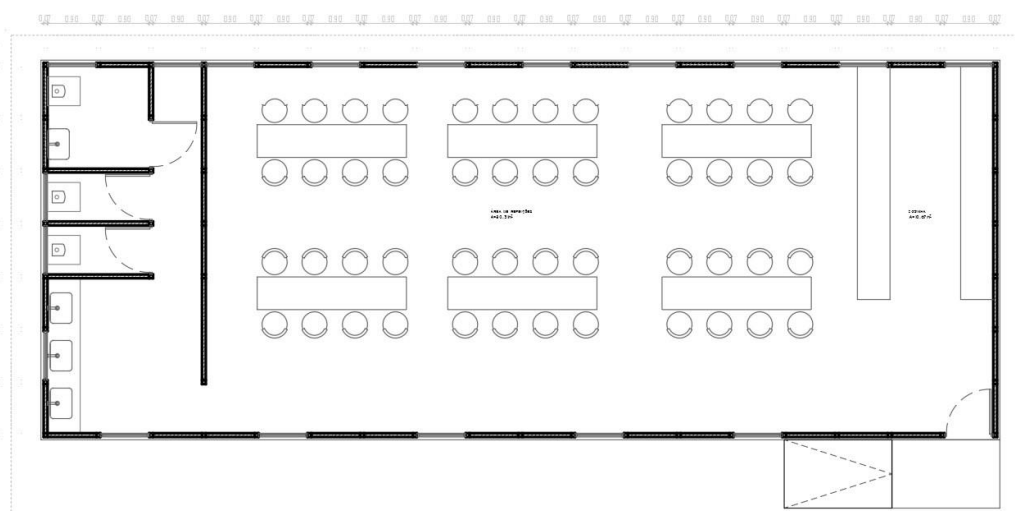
Planta Piso O Módulo Cozinha Comunitária (Fonte: Autor)
